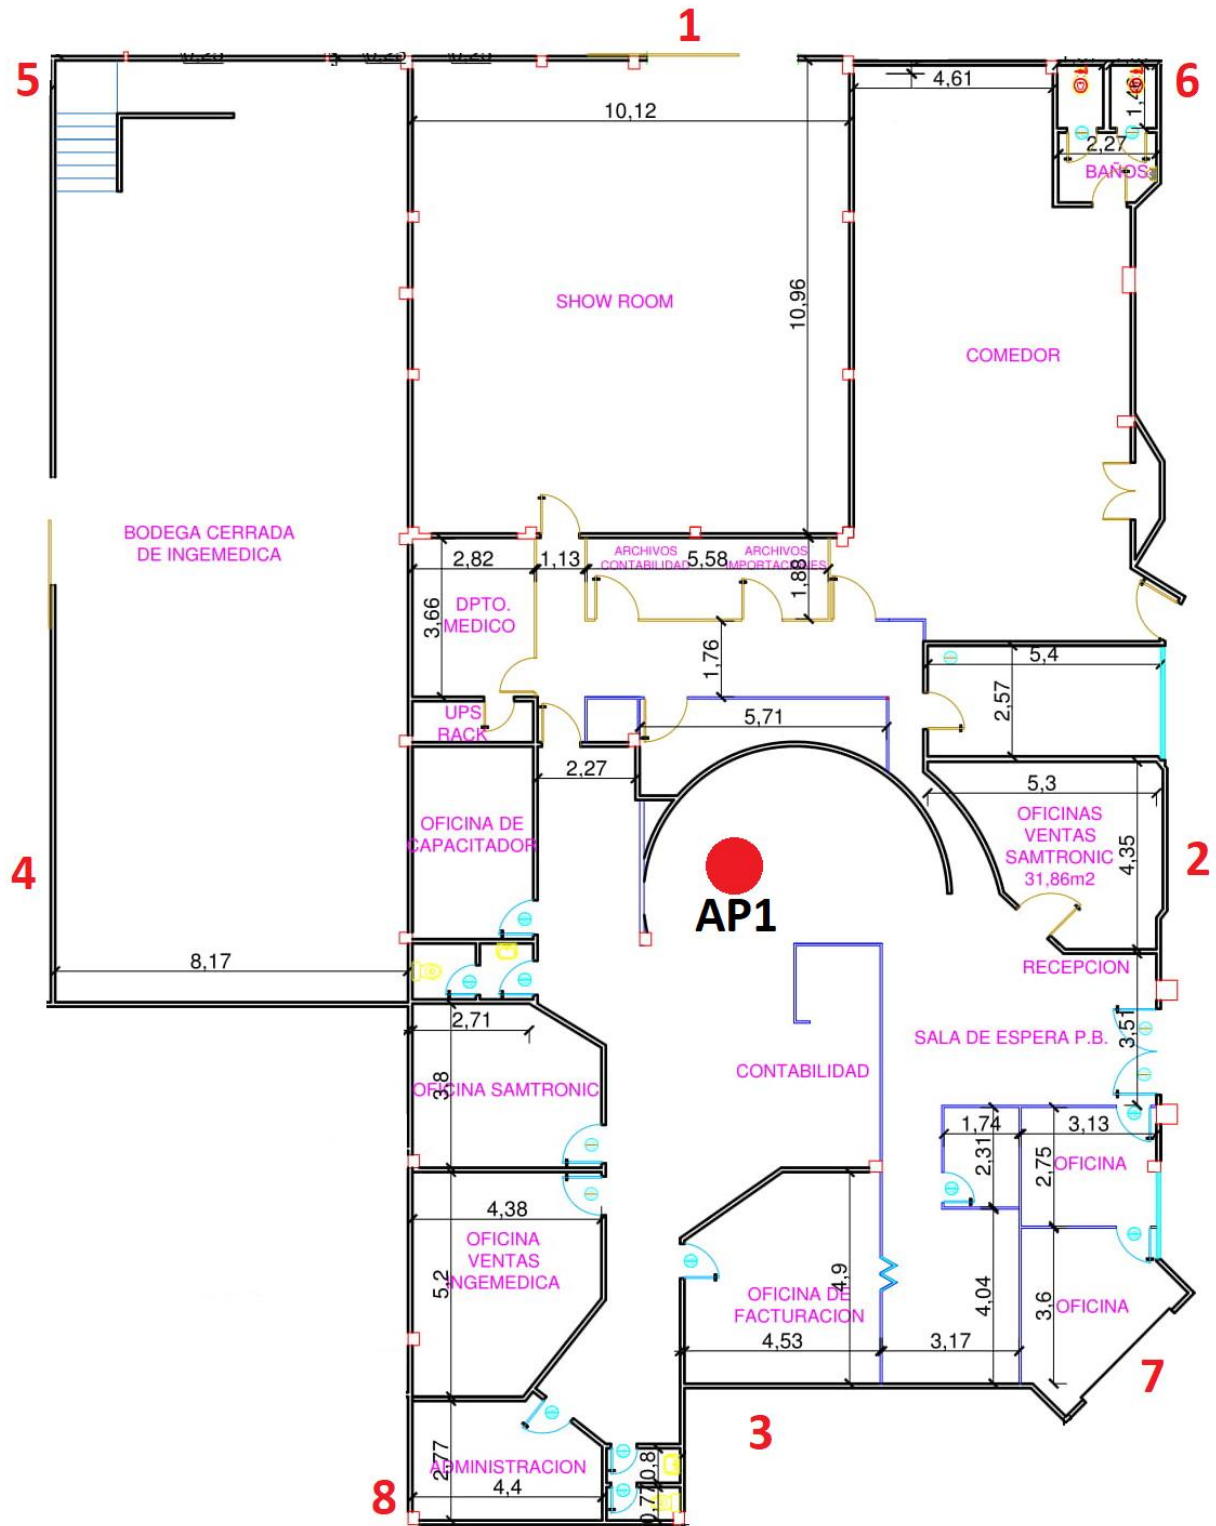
Ubicación de los AP en la planta baja, diseño 1
